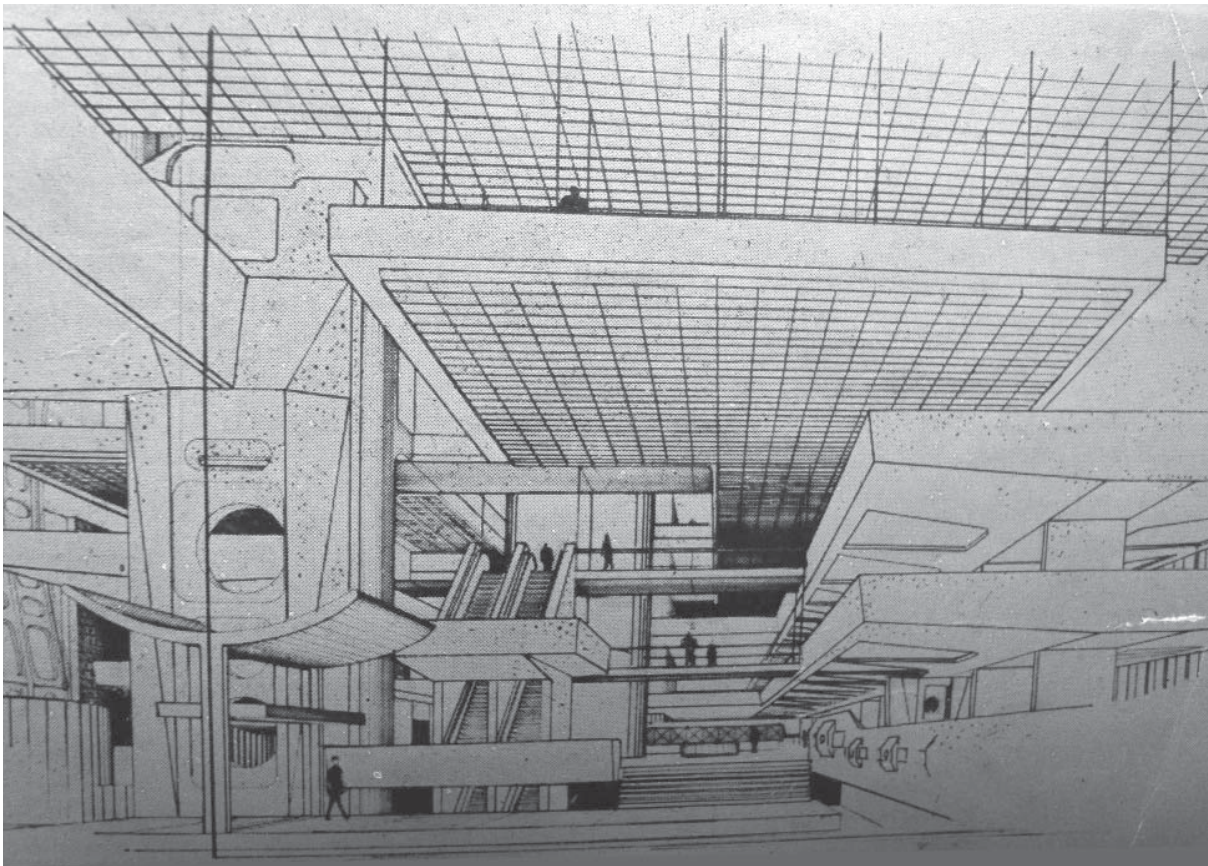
Banco de Londres, perspectiva interna. (Fonte: Construcciones. n.191, 1964.)
